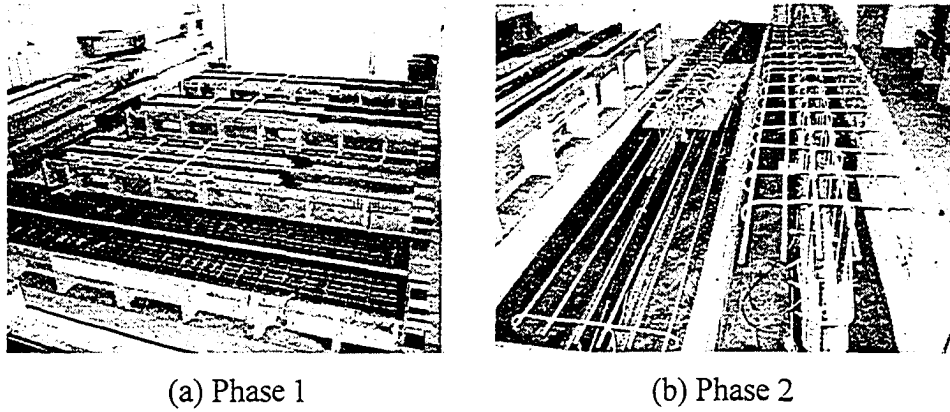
Coffrage et ferrailage des poutres mises à l'essai
